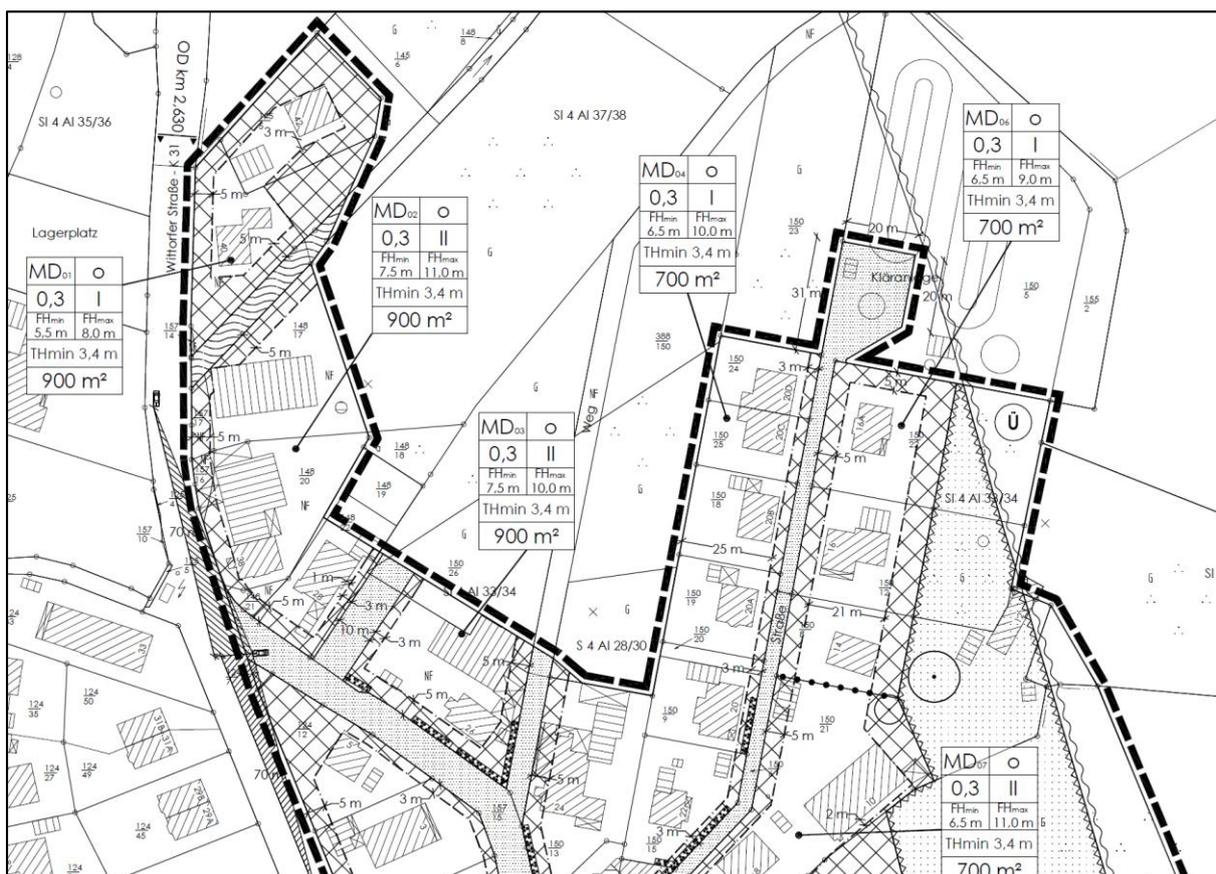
Ausschnitt B-Plan Nr. 35 b
